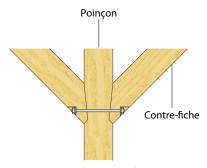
Exemple d'assemblage contrefiche – poinçon par un boulon
